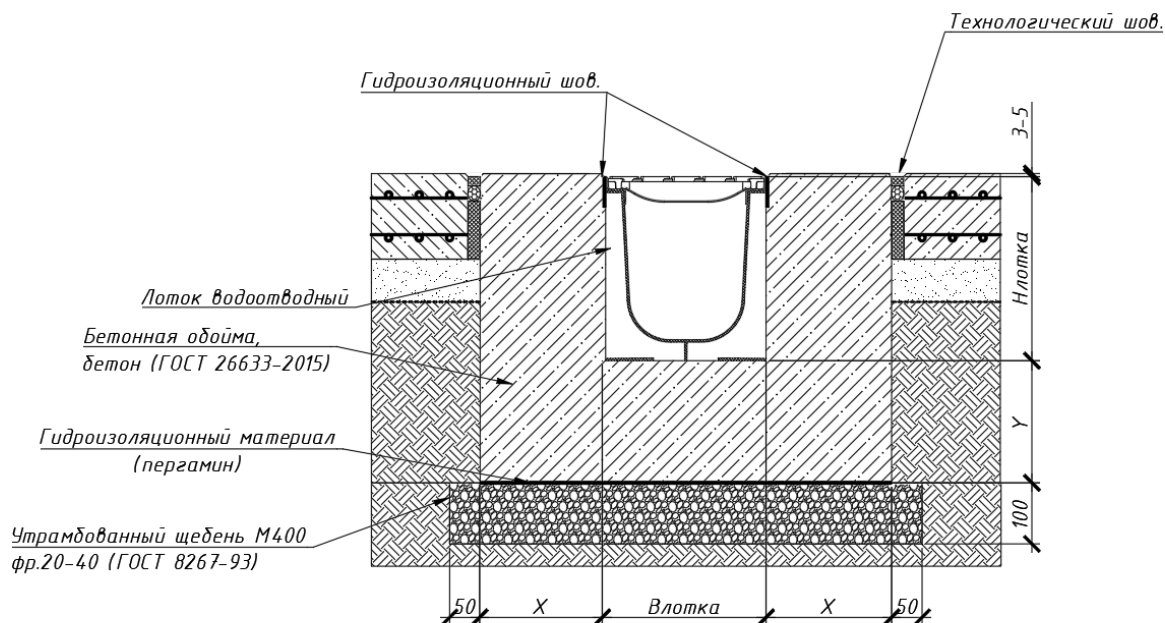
Монтаж пластиковых лотков с бетонным покрытием для высоких классов нагрузки от D400 до E600. Детализовку узлов монтажа пластиковых лотков для всех типов покрытий, технологические швы, узлы гидроизоляции смотреть в «Альбоме типовых решений по монтажу пластиковых водоотводных лотков ООО «Аквасток» 002-001-2014-ТР»
